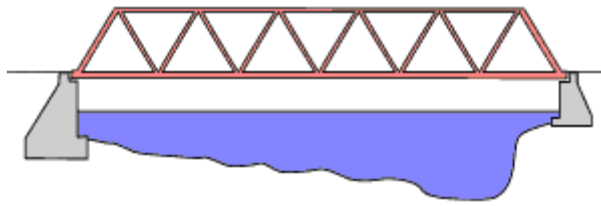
Schéma d'un pont en poutres en treillis type Warren
